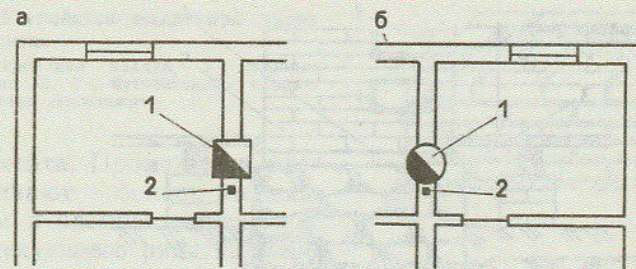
Варианты размещения квадратной и круглой отопительных печей в проеме капитальной стены с устройством дымового канала в кирпичной кладке.
